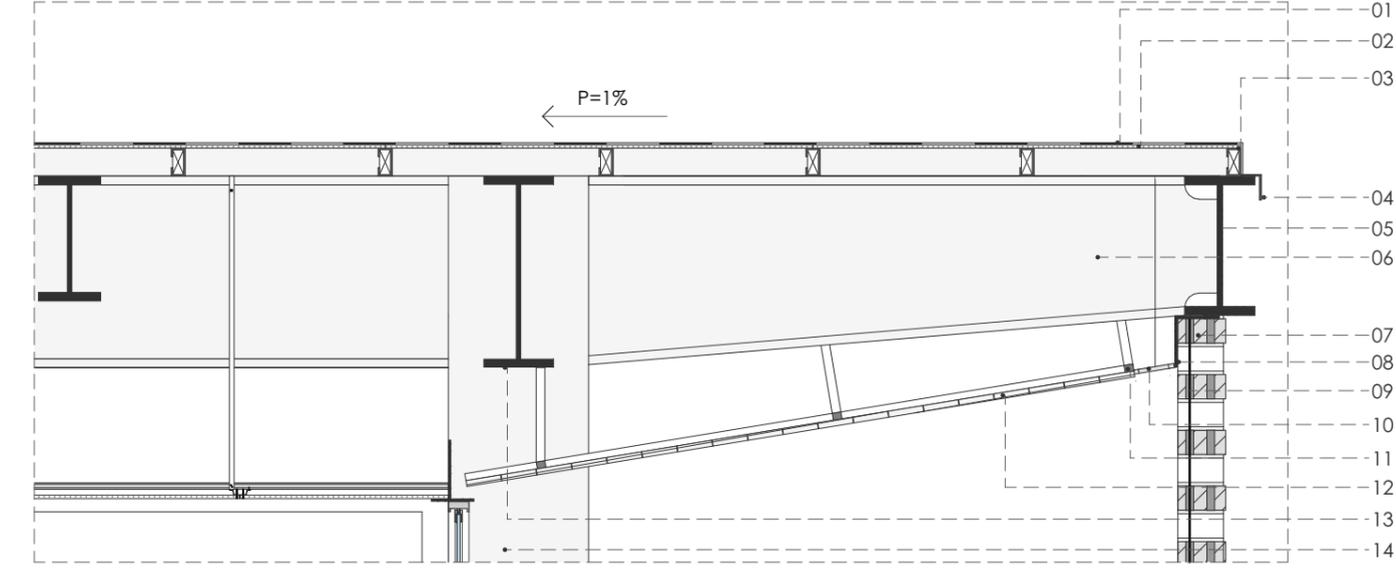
Detalle 04- cubierta Fuente: Propia, 2022
